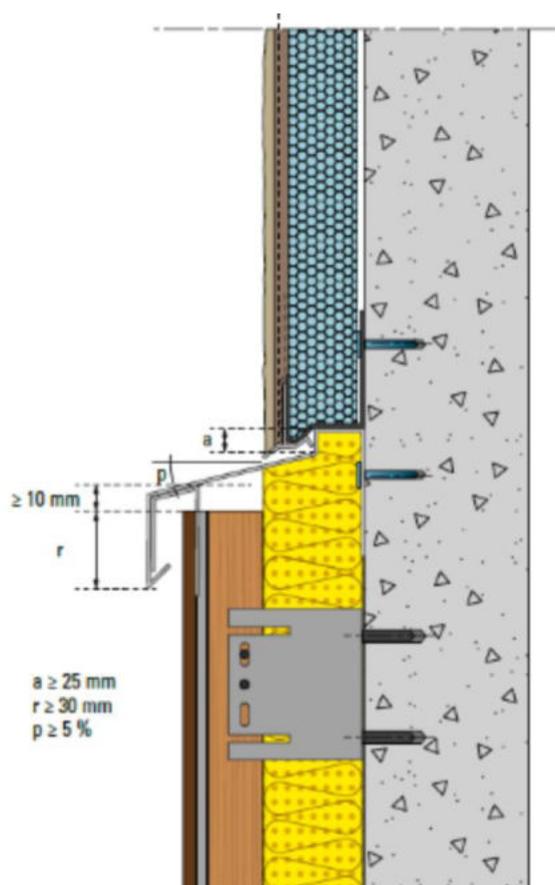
Jonction avec procédé d'enduit sur isolant – coupe verticale – enduit sur isolant en partie haute
